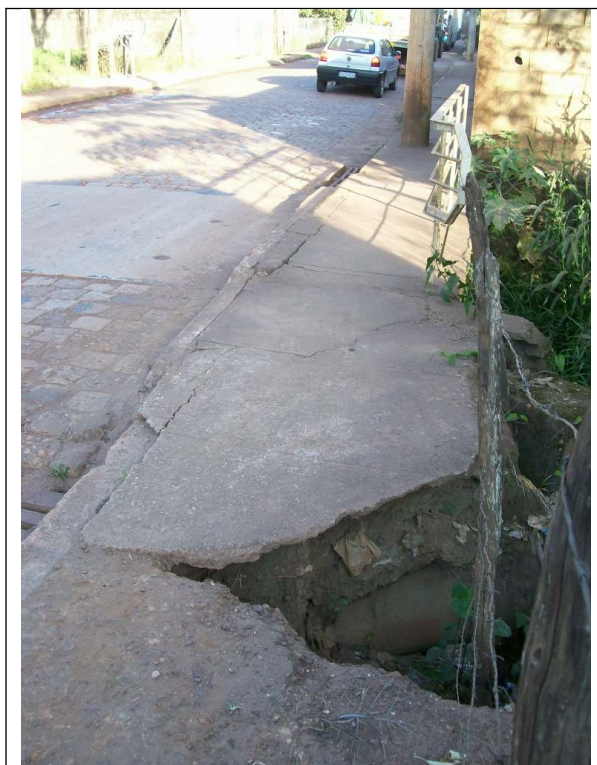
Colapso em pavimento que recobre tubulação de esgoto nas proximidades de ponte existente na Rua Afonso Pena.
